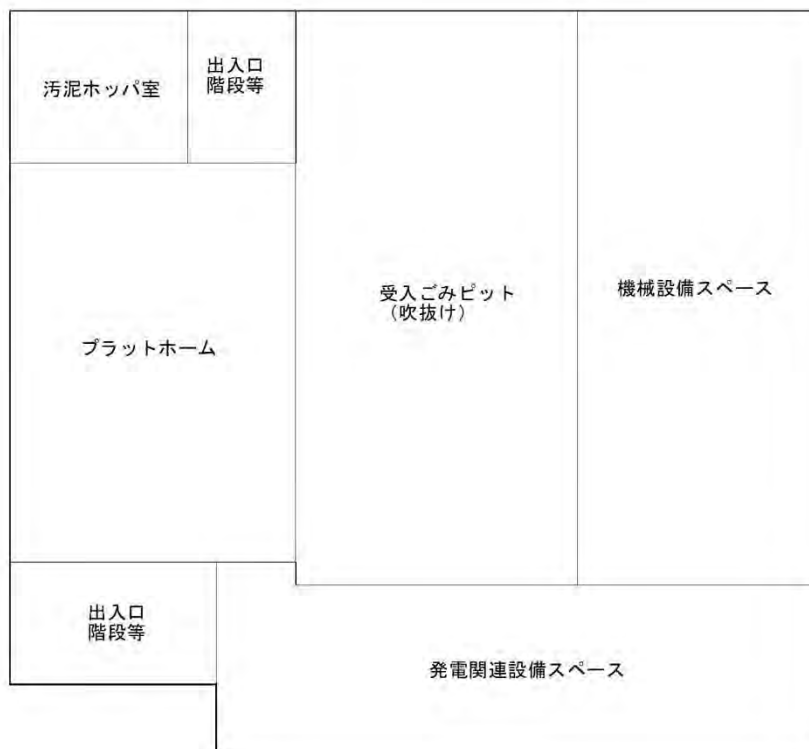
(2) 廃棄物受入棟平面図 (1階)
